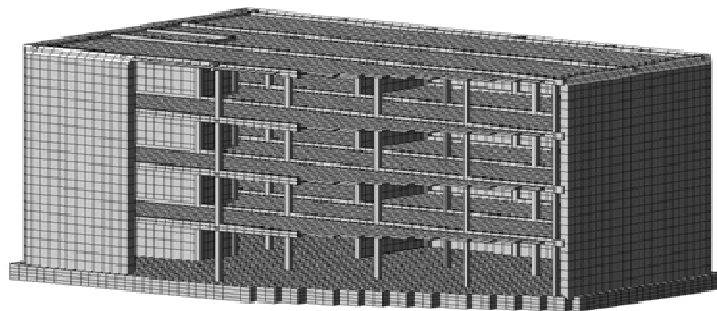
Конечно-элементная расчетная схема здания с плитным фундаментом
